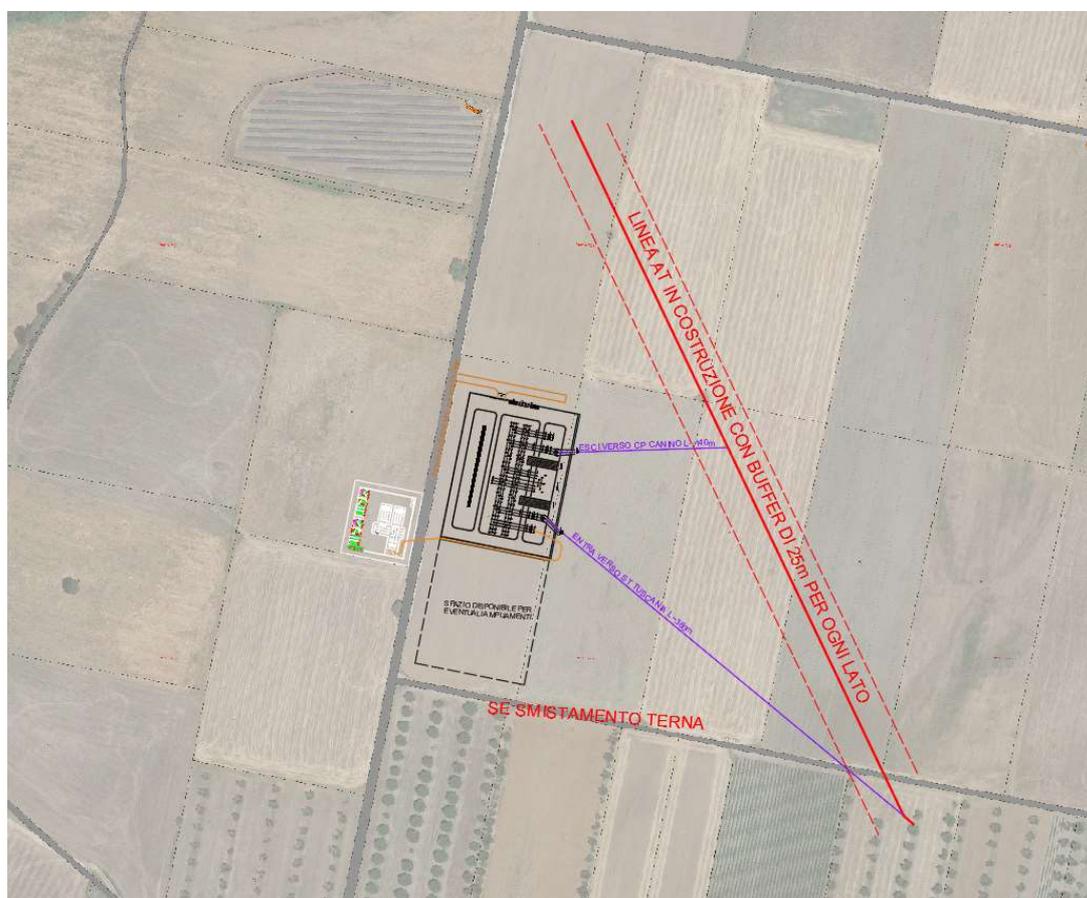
nuova SE e ubicazione stazione elevazione AT/MT
